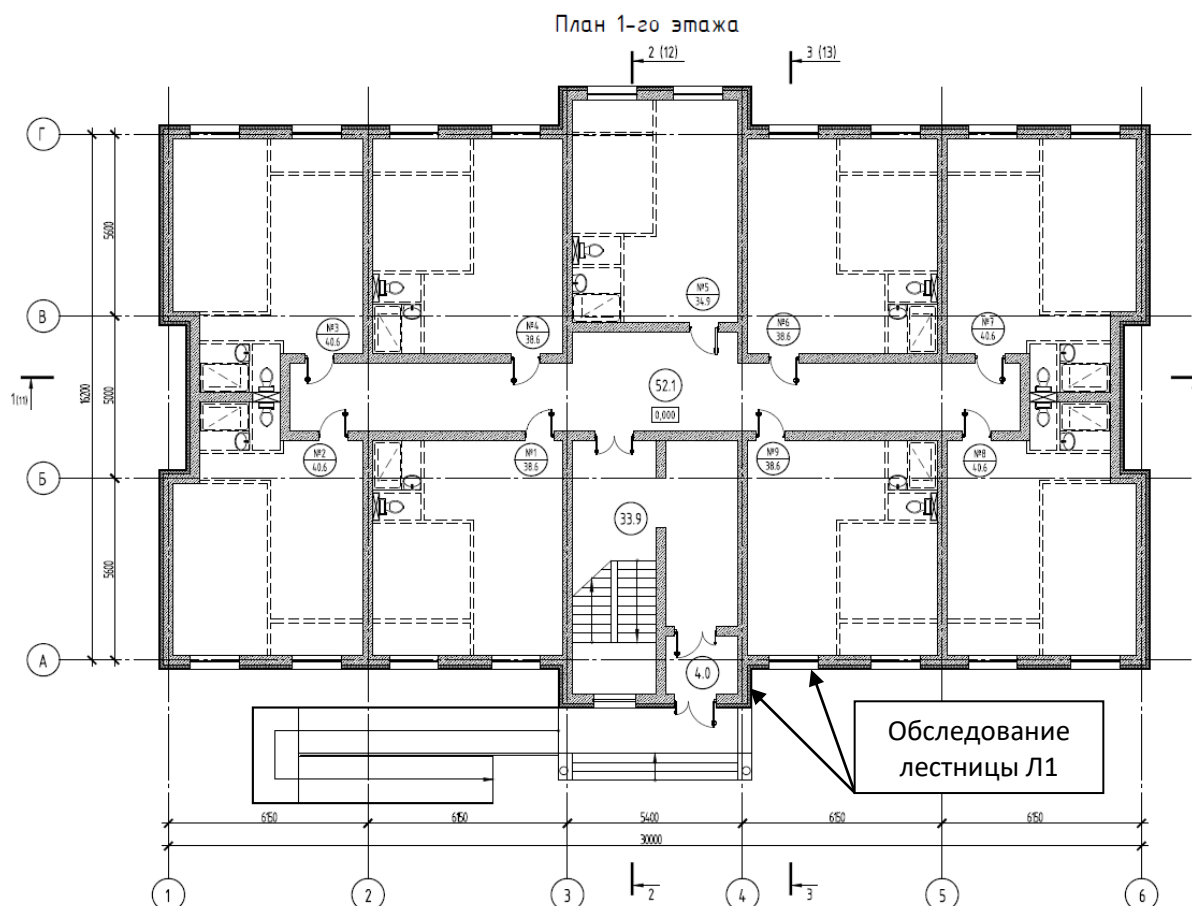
План на отм.0,000 (первый этаж). Обследование лестницы
